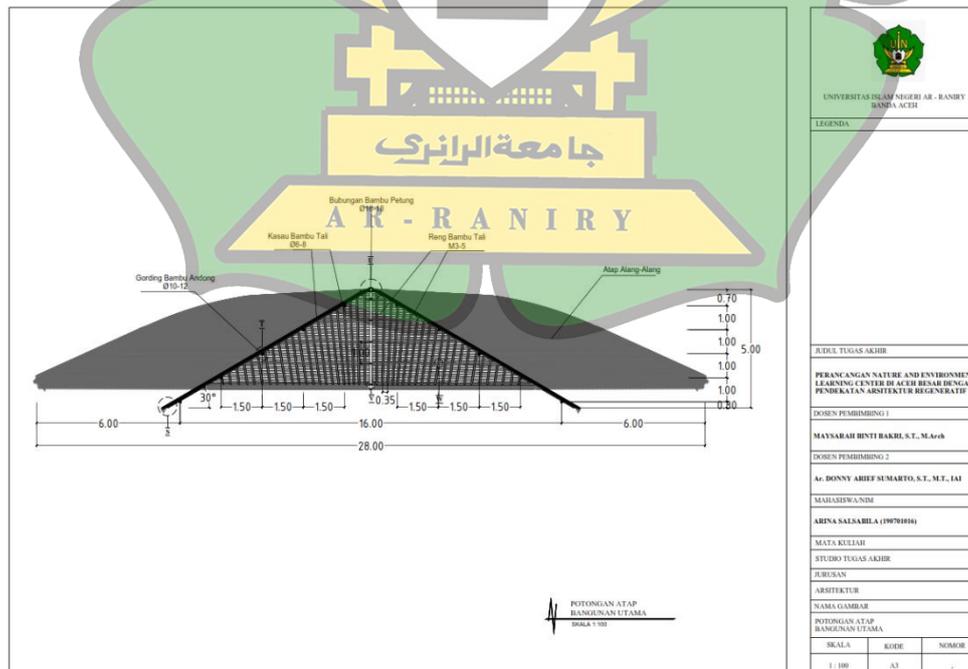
Denah Atap Alang – Alang Bangunan Utama
